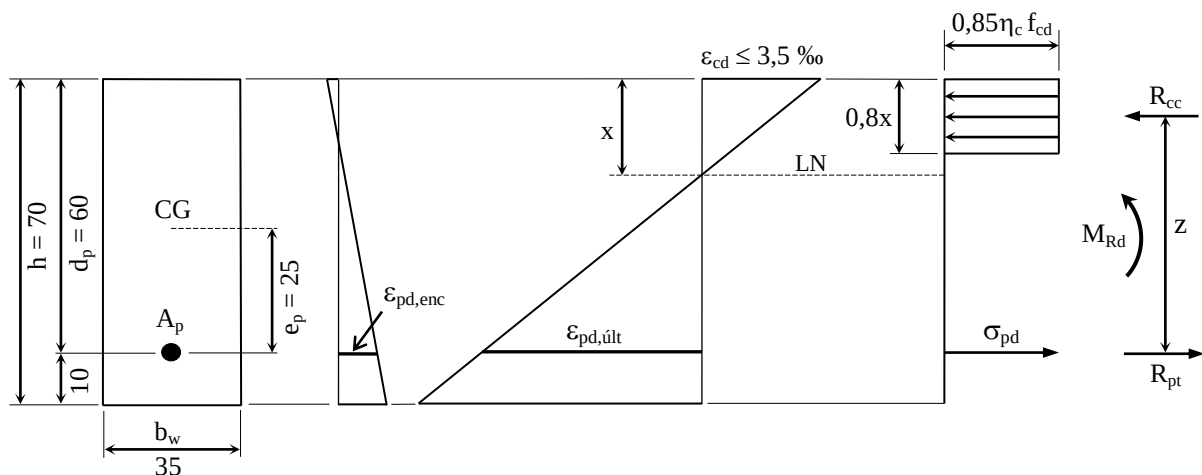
Dimensões (cm) da seção transversal da viga retangular.¹⁸⁸
